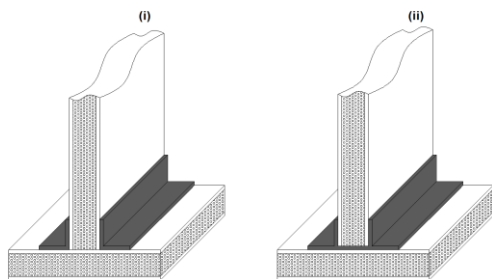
Ligações entre Painéis em “T” (adaptado de [46]).
